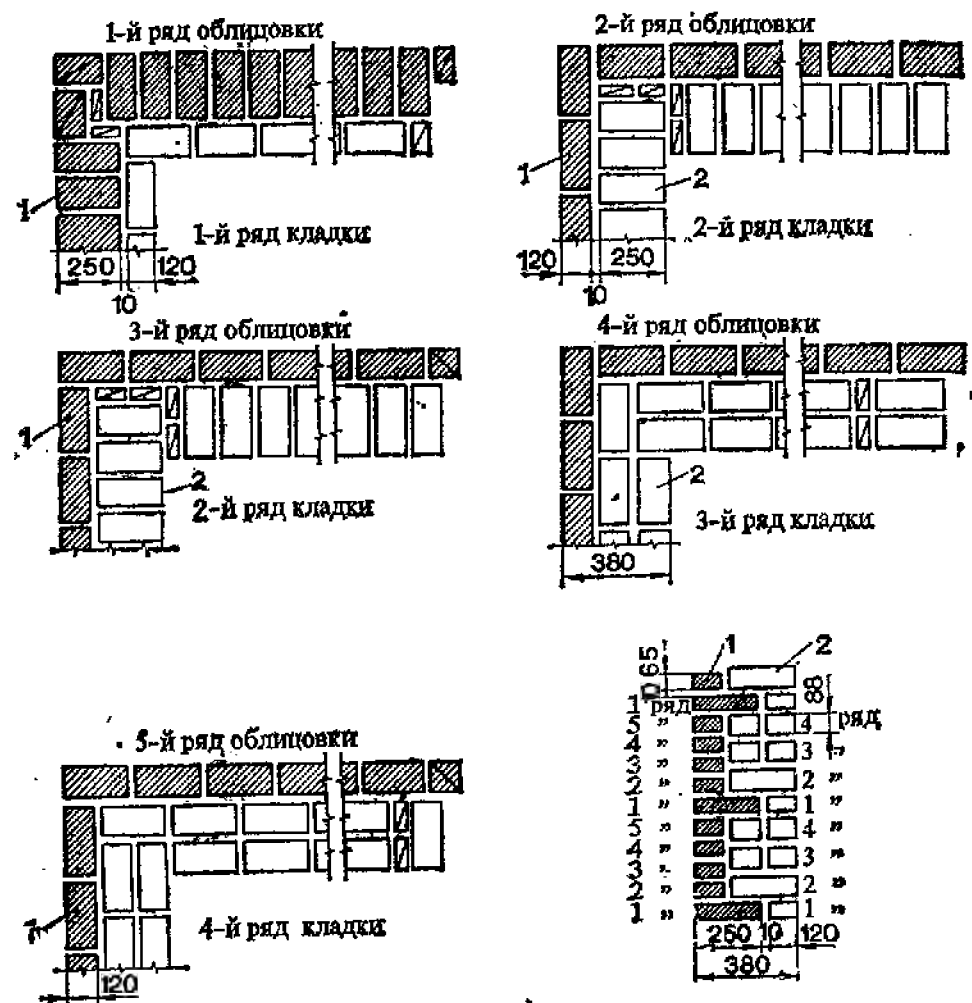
Перевязка кладки из кирпича с облицовкой лицевым кирпичом:
